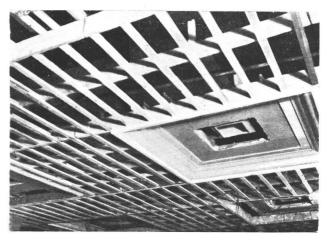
Otro detalle de la instalación del vidrio hilado.
